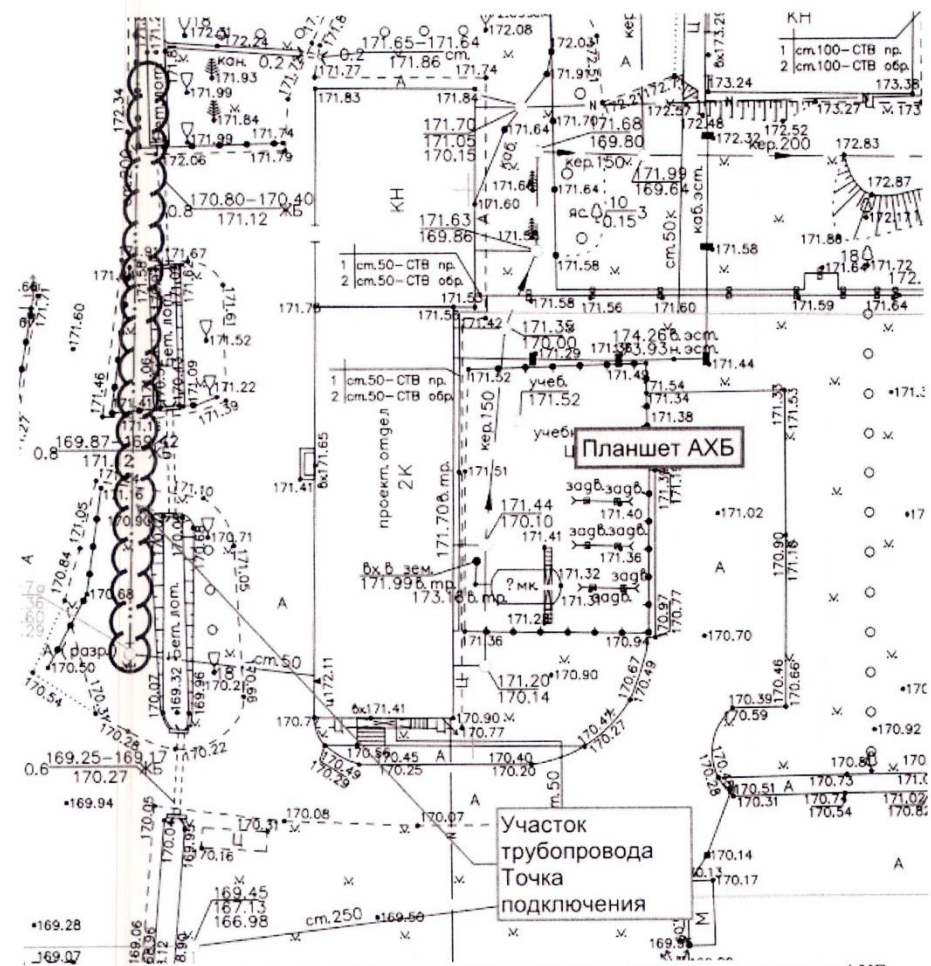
Схема подключения сетей к противопожарному водопроводу на планшете АХБ.
